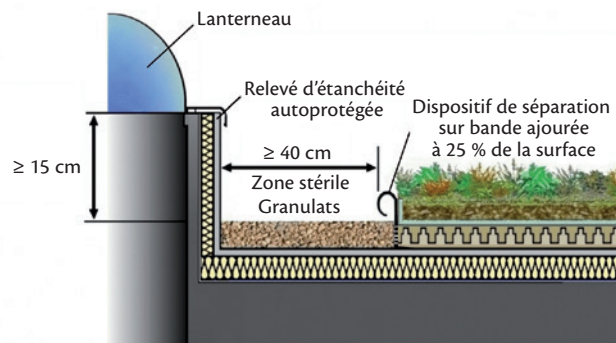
Exemple de relevé d'étanchéité avec lanterneau
